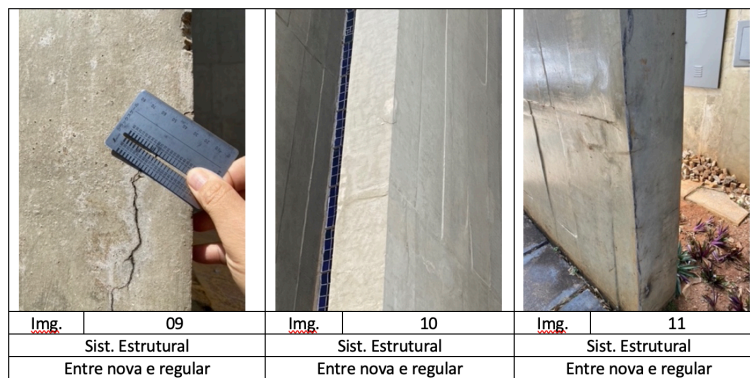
Fissuras na base e corpo do pilar da estrutura de concreto híbrida - Fachada Norte.
